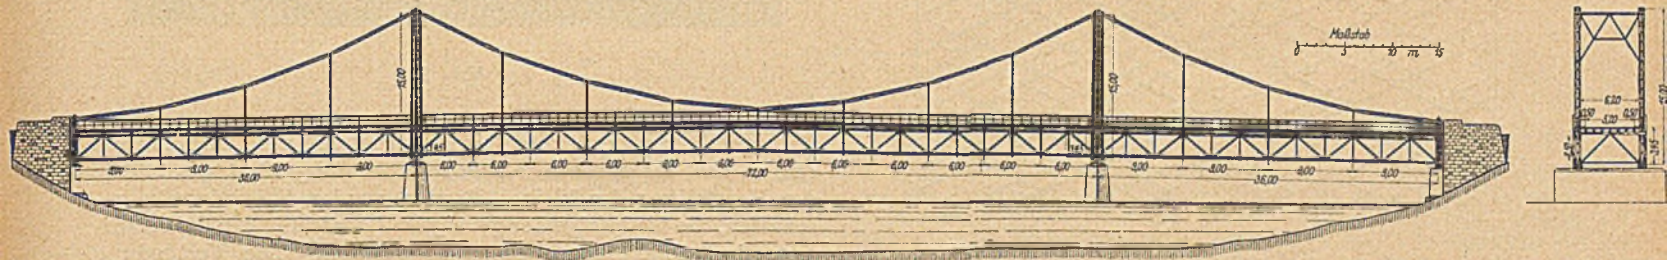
Entwurf einer Hängebrücke in Holzkonstruktion nach Bauweise Siemens-Bauunion.
